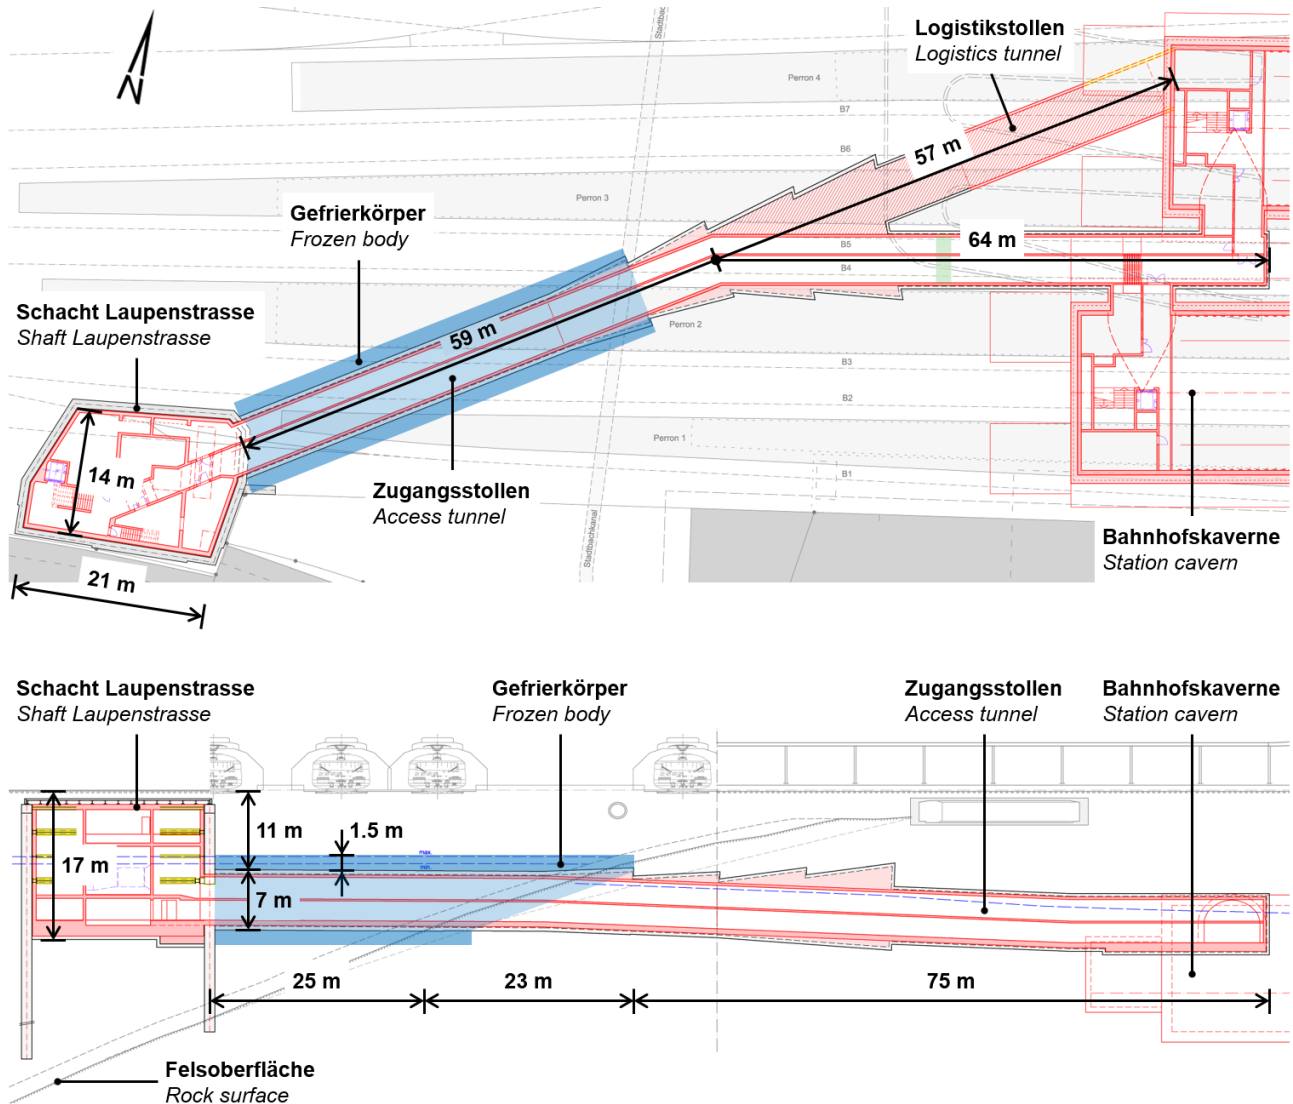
Schacht und Stollen Laupenstrasse – oben: Situation; unten: Längsschnitt [6]
